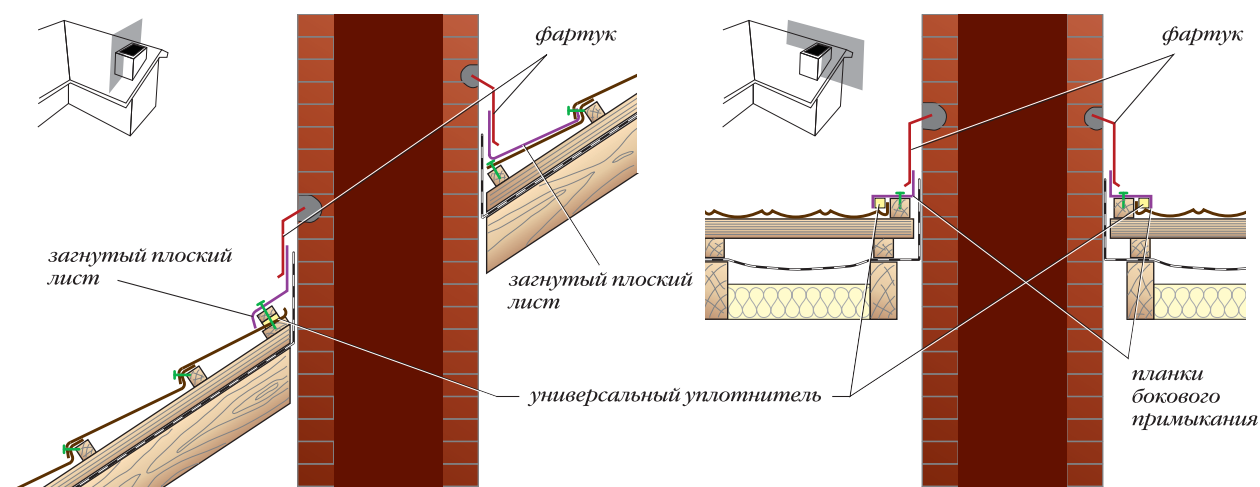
Вариант примыкания кровли из композитной металлочерепицы к трубе
